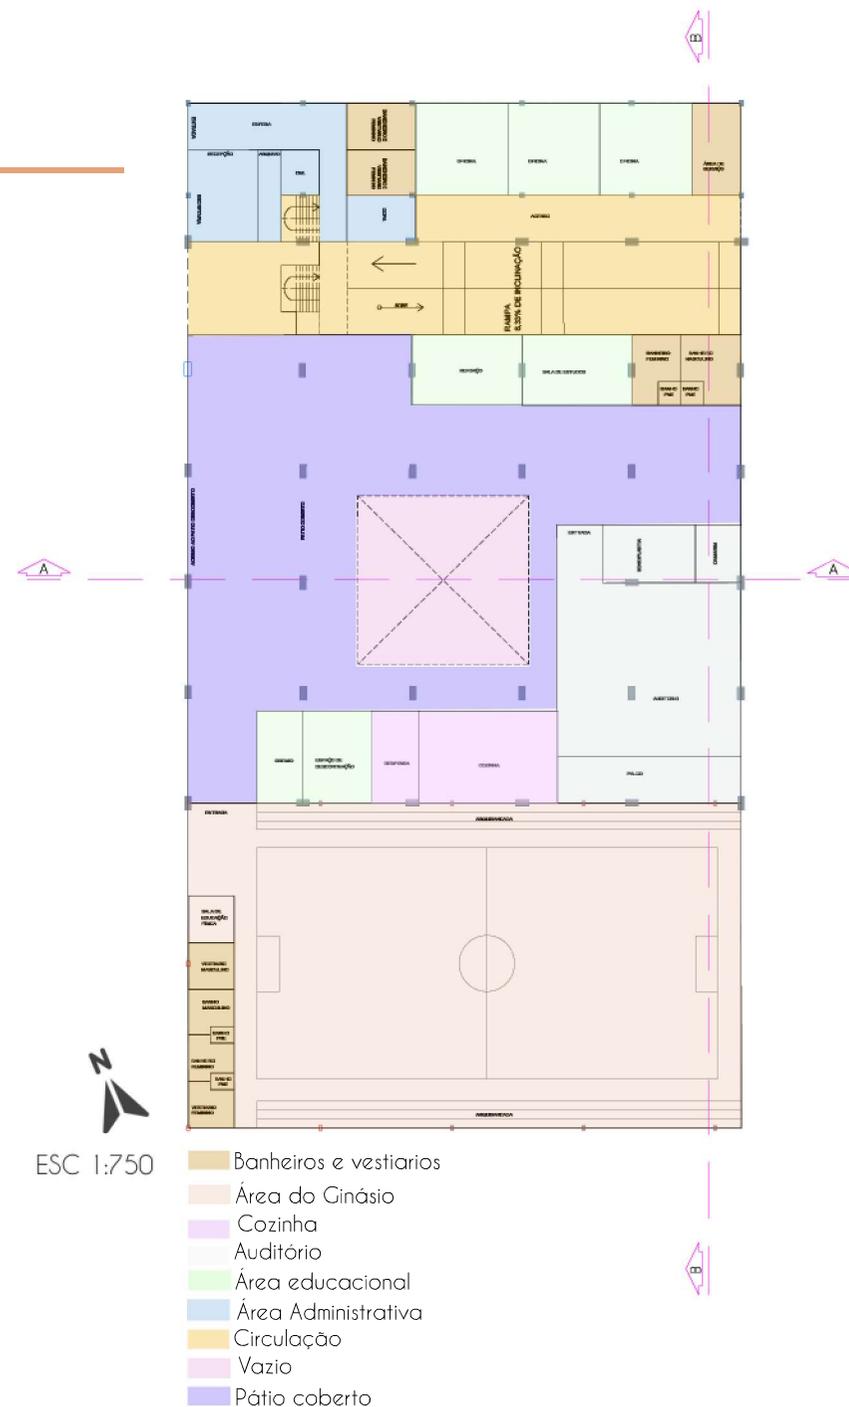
Planta Estrutural- Fonte: Desenvolvido pela autora
